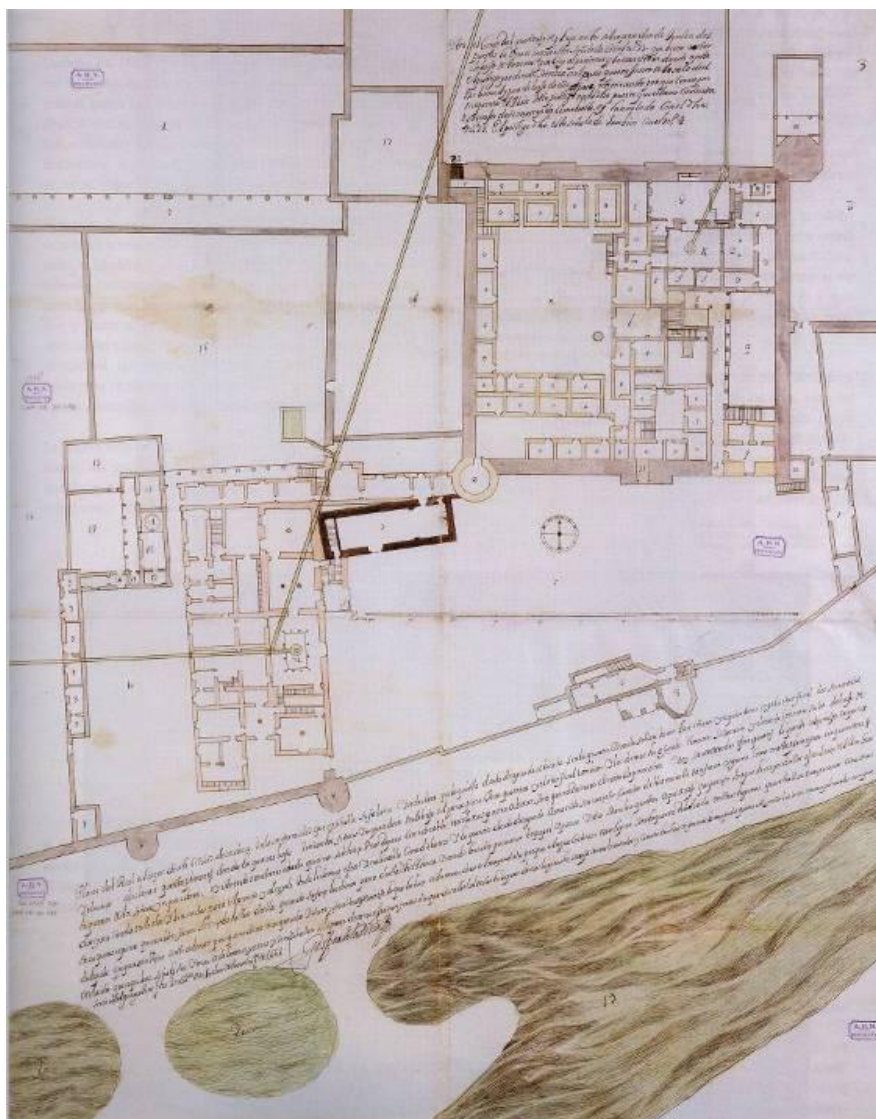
Anónimo, 1662: Planta del Alcázar de Córdoba
